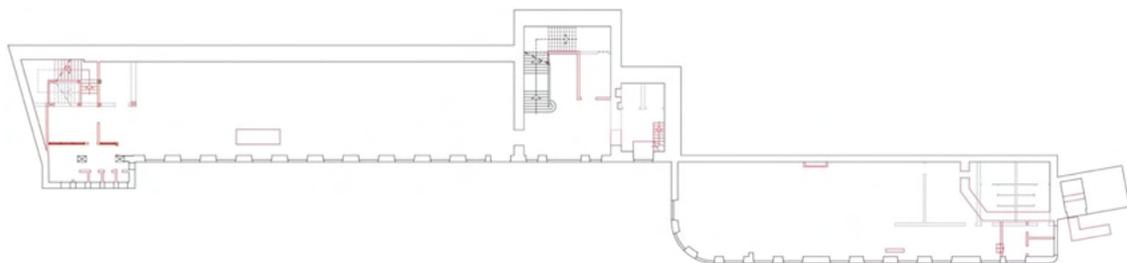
Planta existente do piso térreo. A vermelho as alterações propostas.
